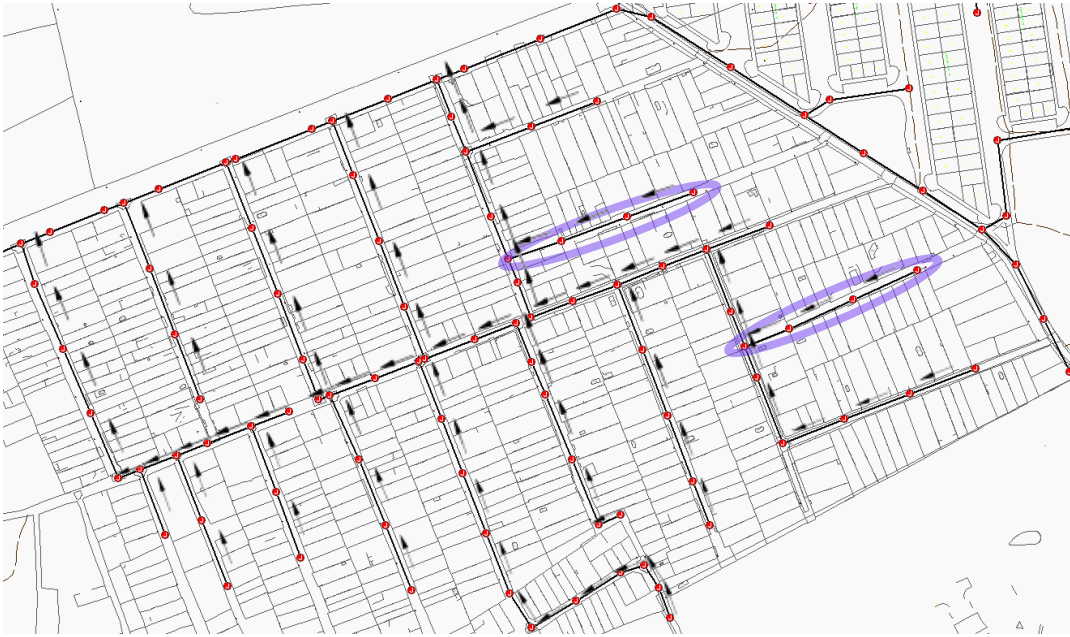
Segunda Proposta de Traçado da Rede do Cond. Mansão Par.
